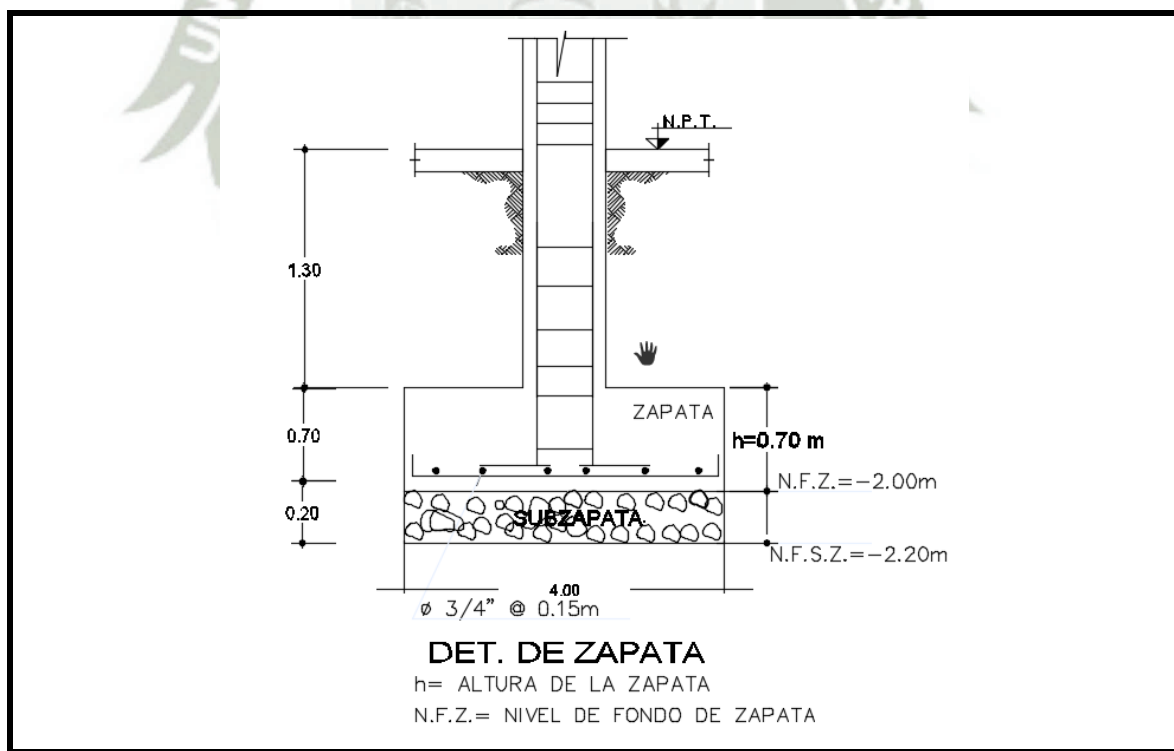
B: Diseño final sección en elevación (Z-1).
